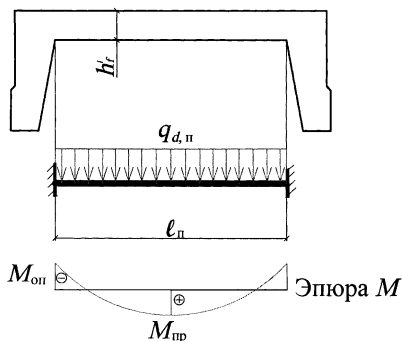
Расчетная схема полки плиты и эпюра моментов
